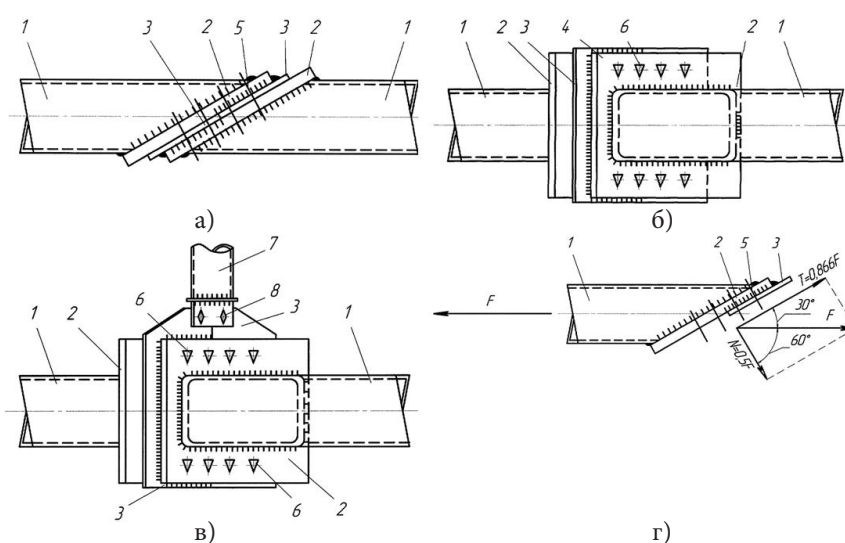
Предлагаемое фланцевое соединение растянутых элементов замкнутого профиля: а – вид сверху; б – вид сбоку; в – вид сбоку для случая прикрепления элемента решетки; г – расчетная схема; 1 – растянутые элементы замкнутого профиля; 2 – фланцы; 3 – опорные столики; 4 – выступающие части фланцев; 5 – соосные отверстия; 6 – стяжные болты; 7 – стержневой элемент решетки; 8 – дополнительные болты
